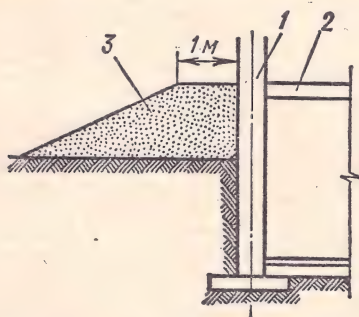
Обсыпка грунтом полуподвальных помещений:
